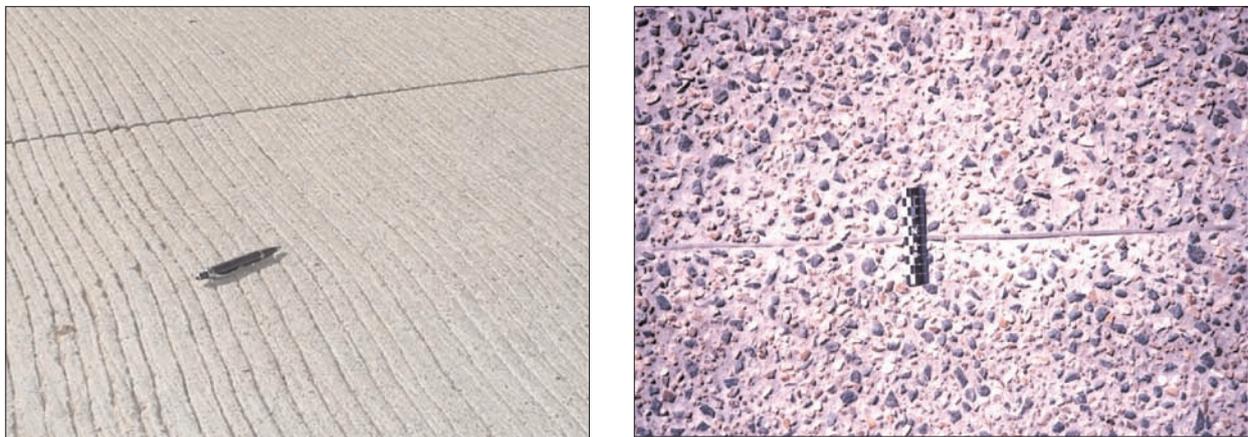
Detalle de diversas texturas: pavimento de hormigón cepillado (izquierda) y de árido visto (derecha).
